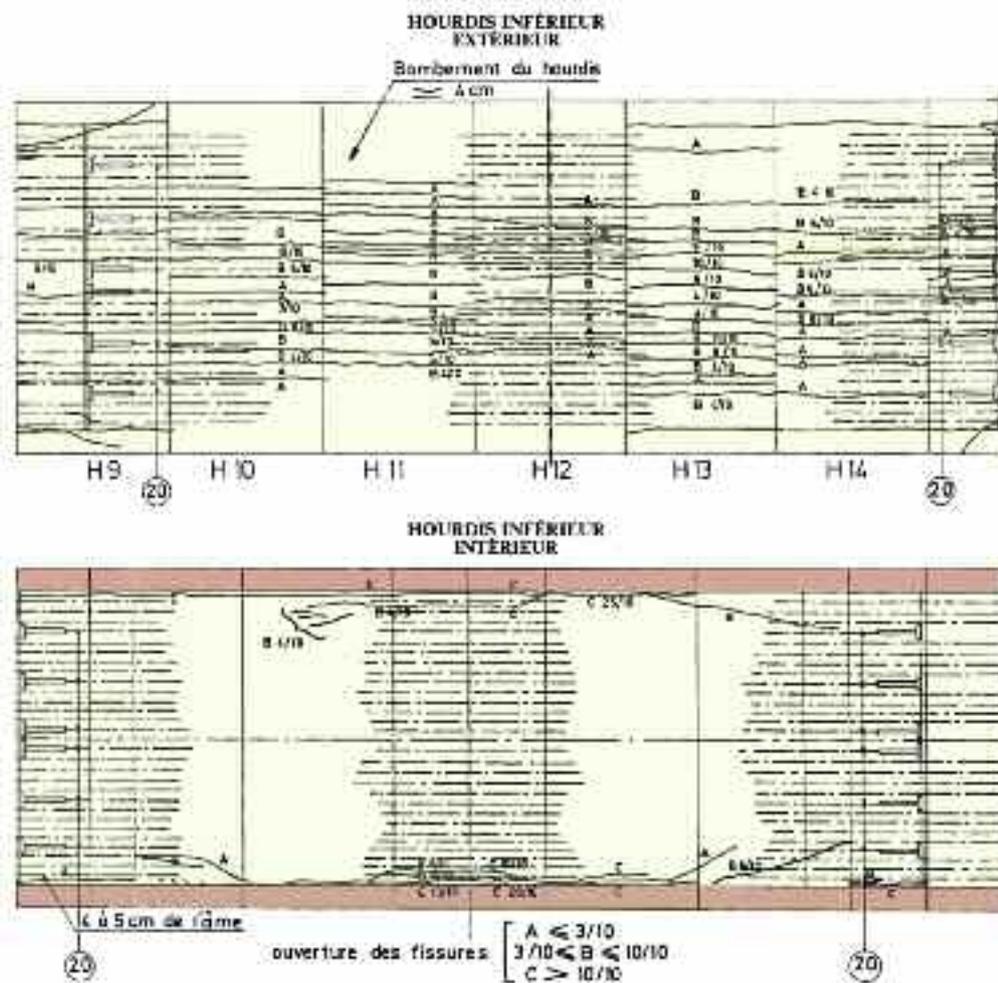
plan de fissuration indiquant les fissures à injecter
